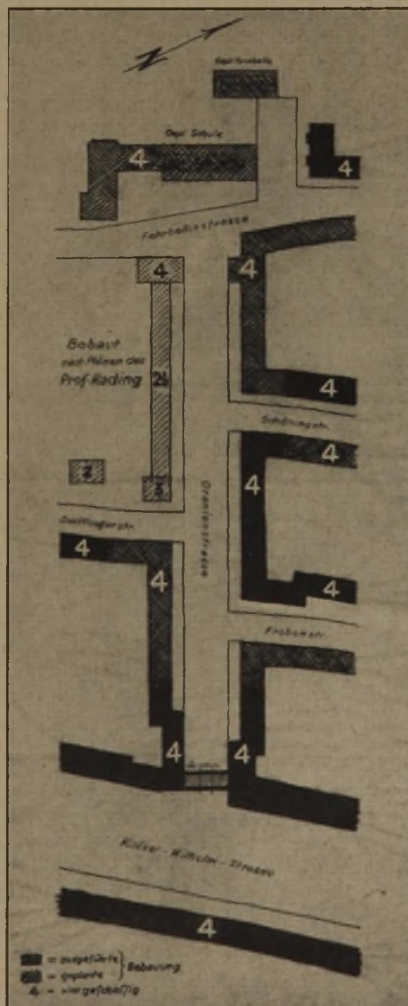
Lageplan. Häuserreihe an der Oranienstr. in Breslau.
